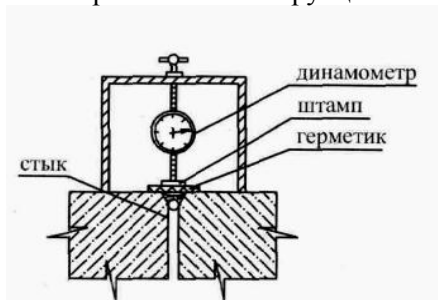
Принцип работы адгезиометра для оценки сцепления герметика с поверхностью конструкции.
